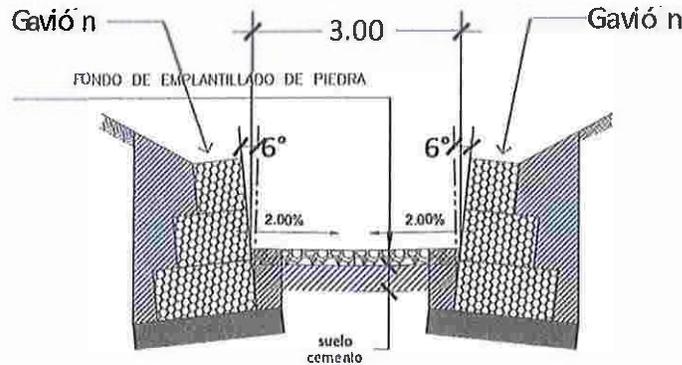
Sección esquemática de canaleta auxiliar y gaviones.
